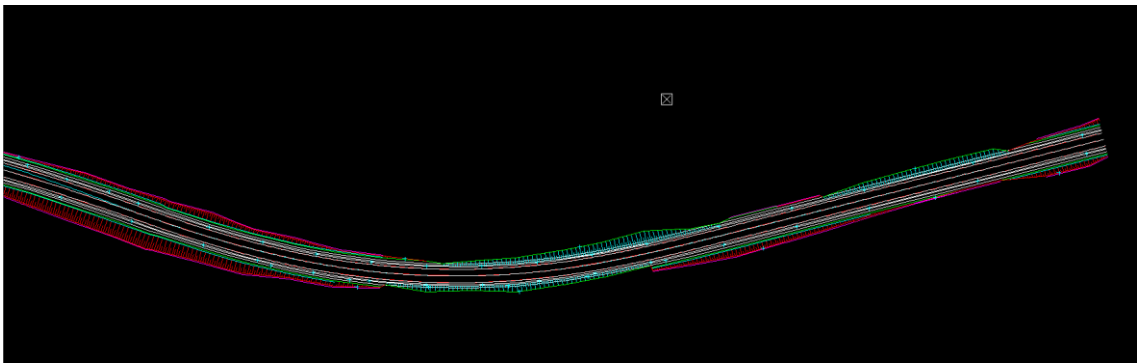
Imagen de la carretera en planta (Plano a escala en el apartado de "Cartografía"). Fuente: Elaboración propia mediante Istram.
